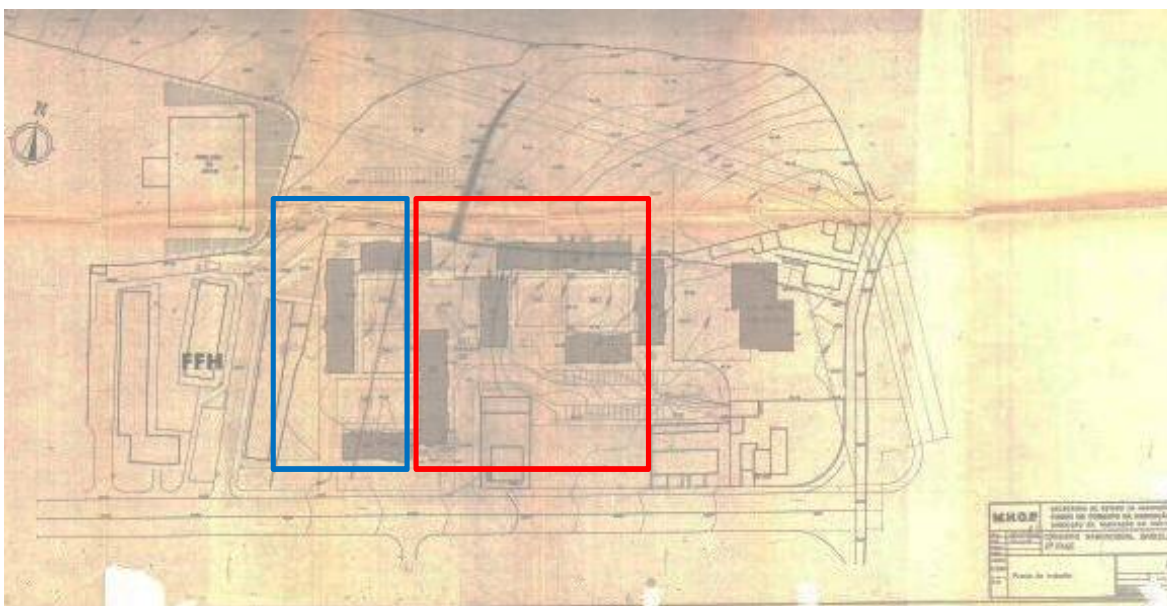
Planta Geral- 1 Fase,  2 Fase
